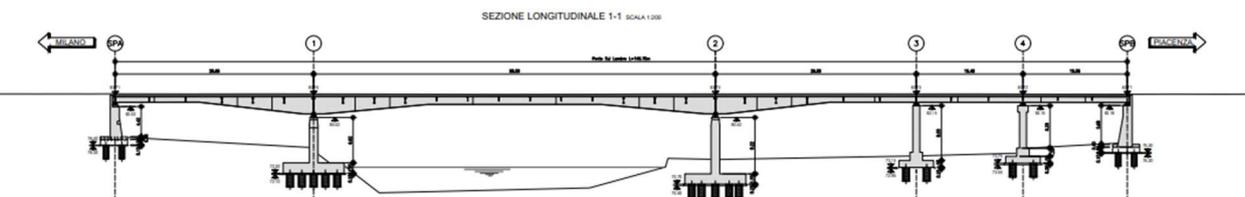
Sezione Longitudinale Viadotto Lambro – configurazione modificata
